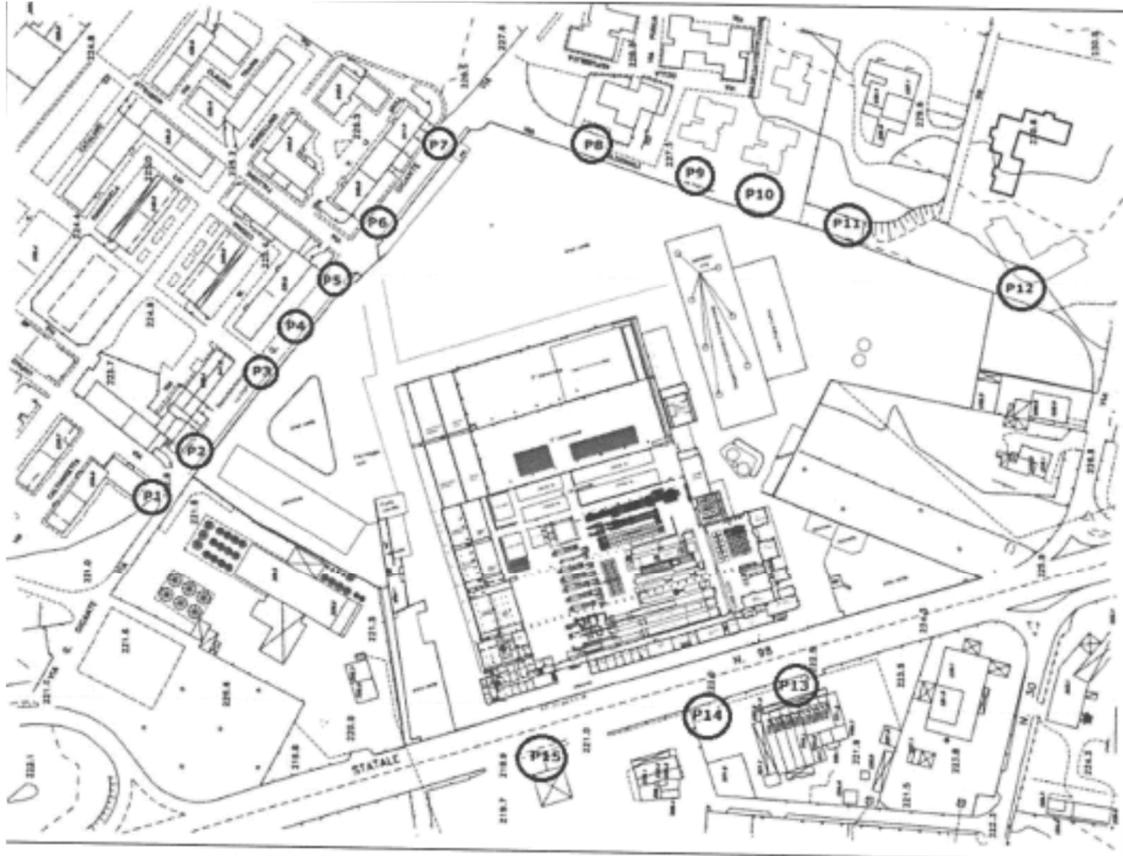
Planimetria dell'area interessata e individuazione dei punti di osservazione
